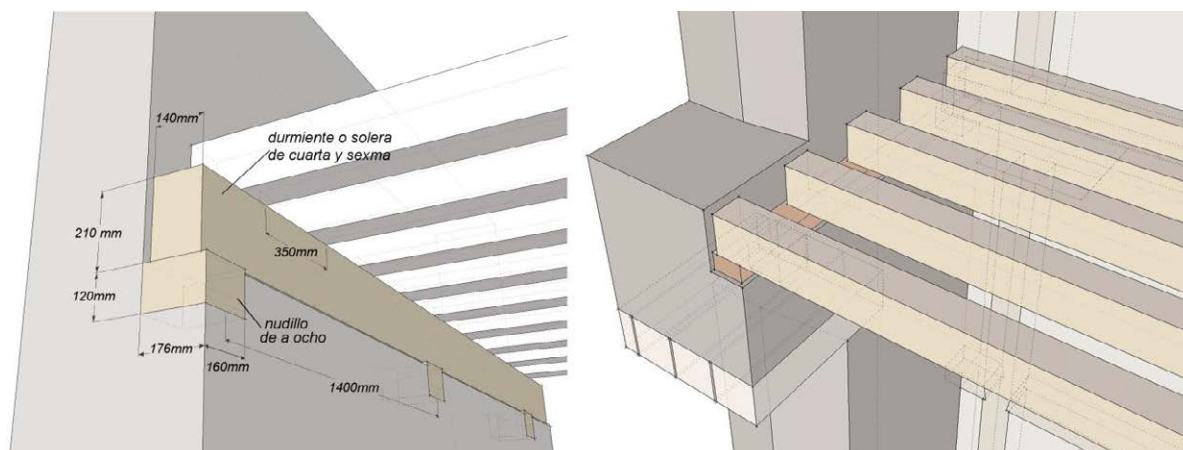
Apoyo del forjado en el muro de fachada mediante solera y nudillos
